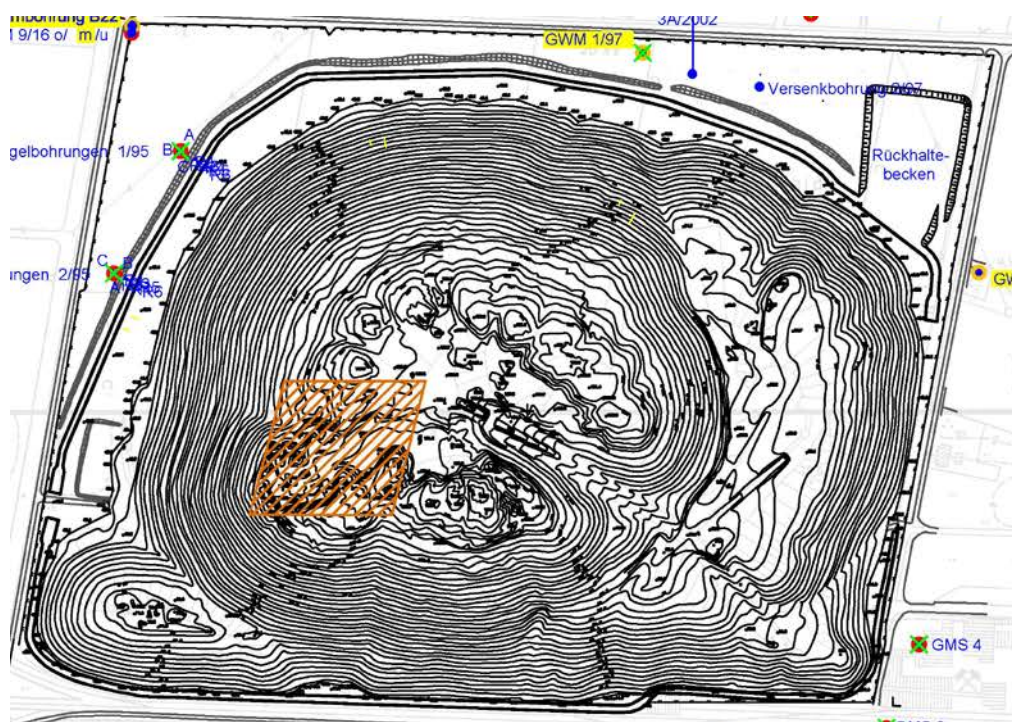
Lage der Hausmülldeponie (schraffiert) (K+S 2017, Unterlage F-1.1)
